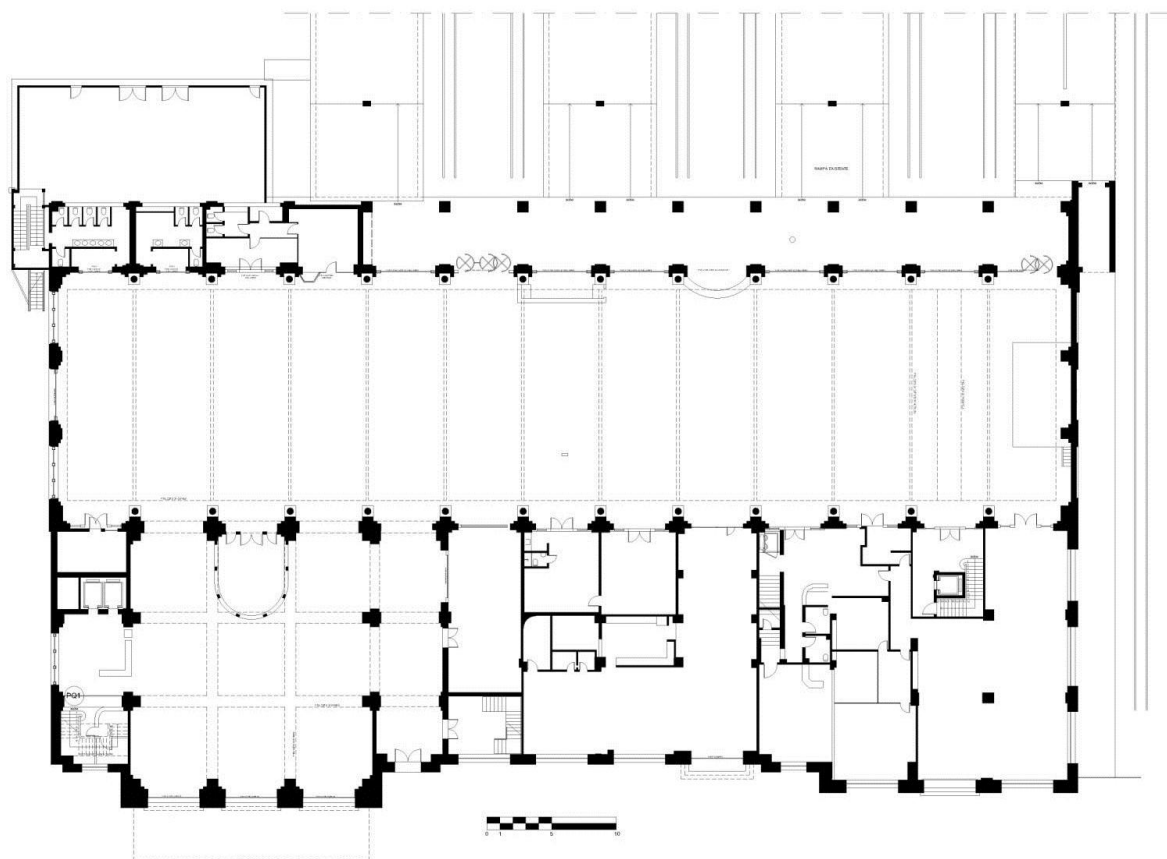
Planta baixa, 1º pavimento – Situação atual
